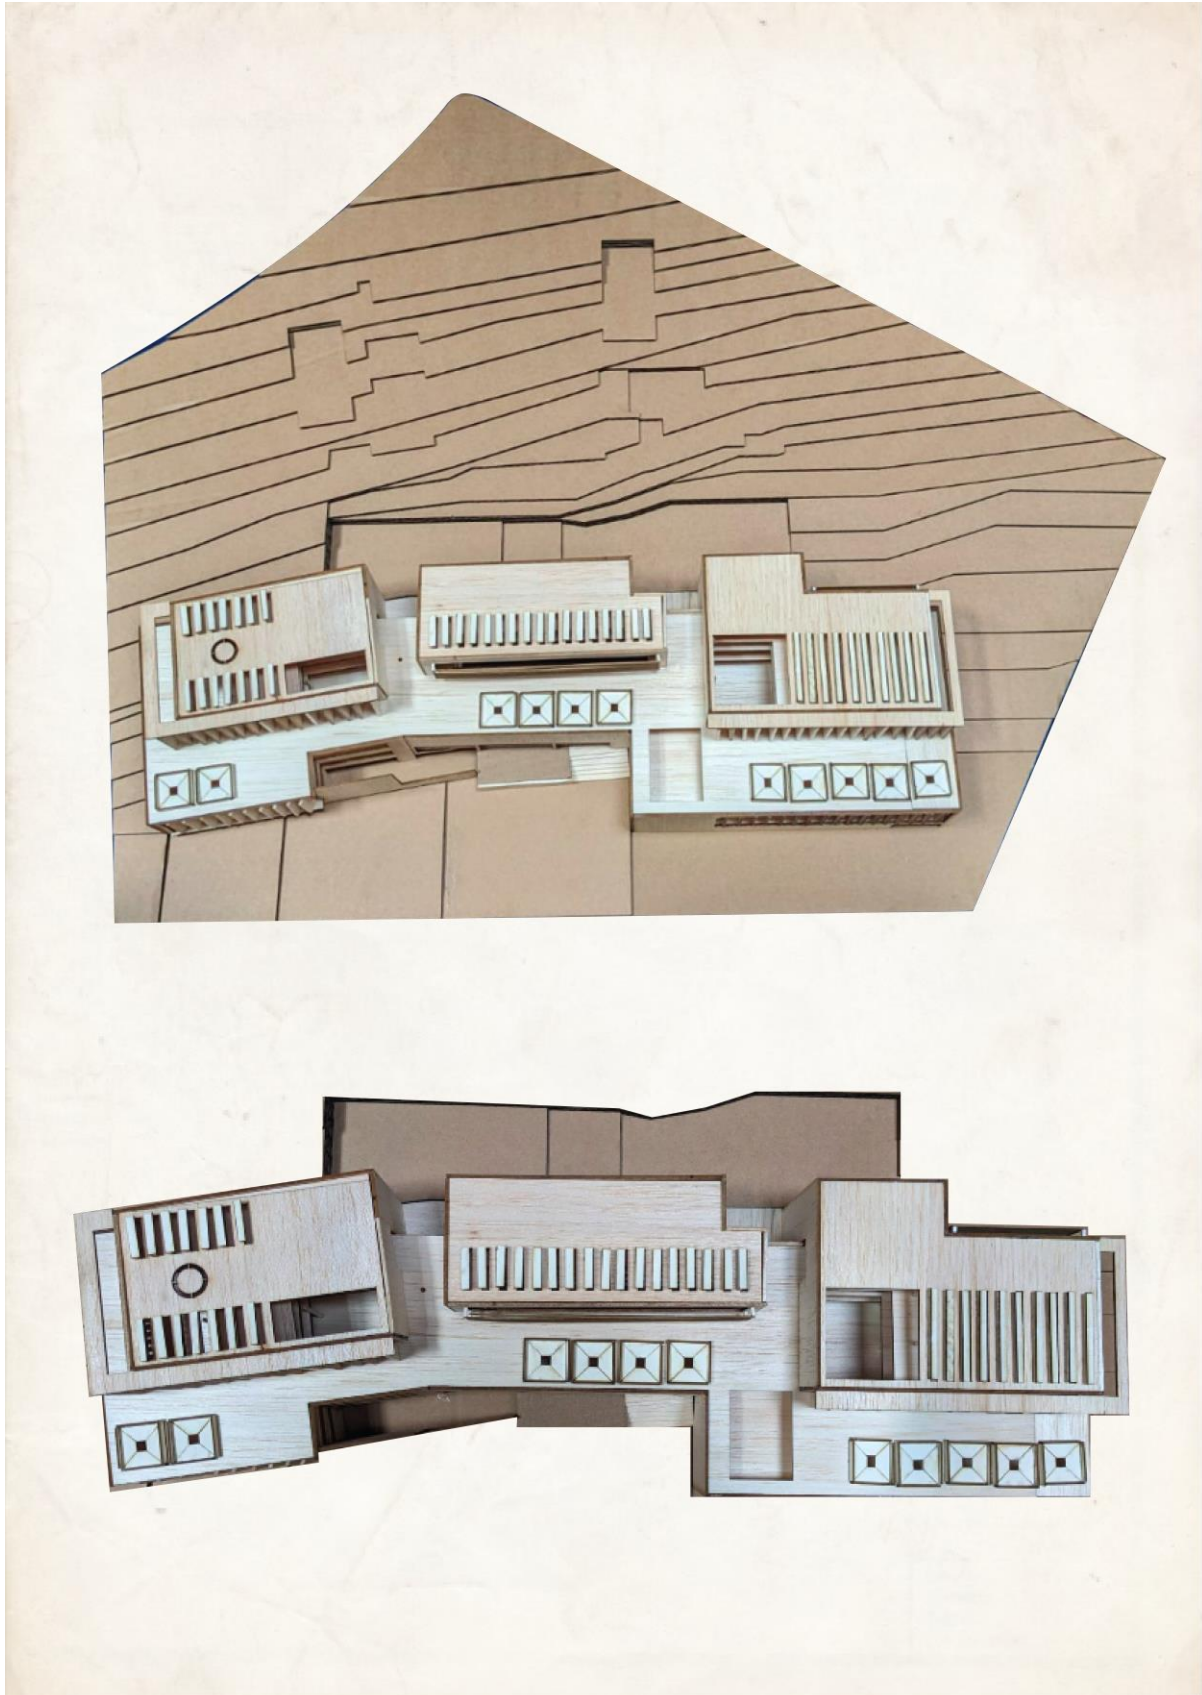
Maqueta del mercado minorista. Elaboración Propia
